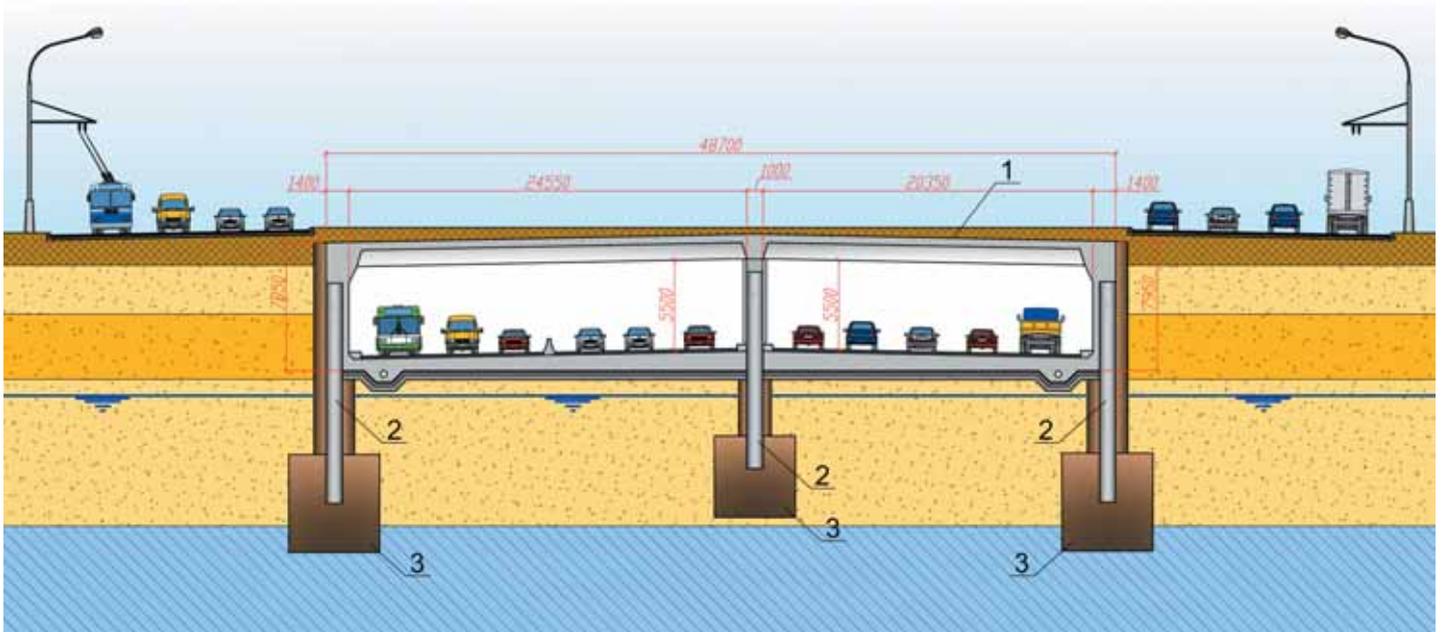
Поперечное сечение закрытой части тоннеля на Ленинградском проспекте: 1 – конструкция тоннельной обделки; 2 – буронабивные сваи; 3 – грунтоцементный массив
